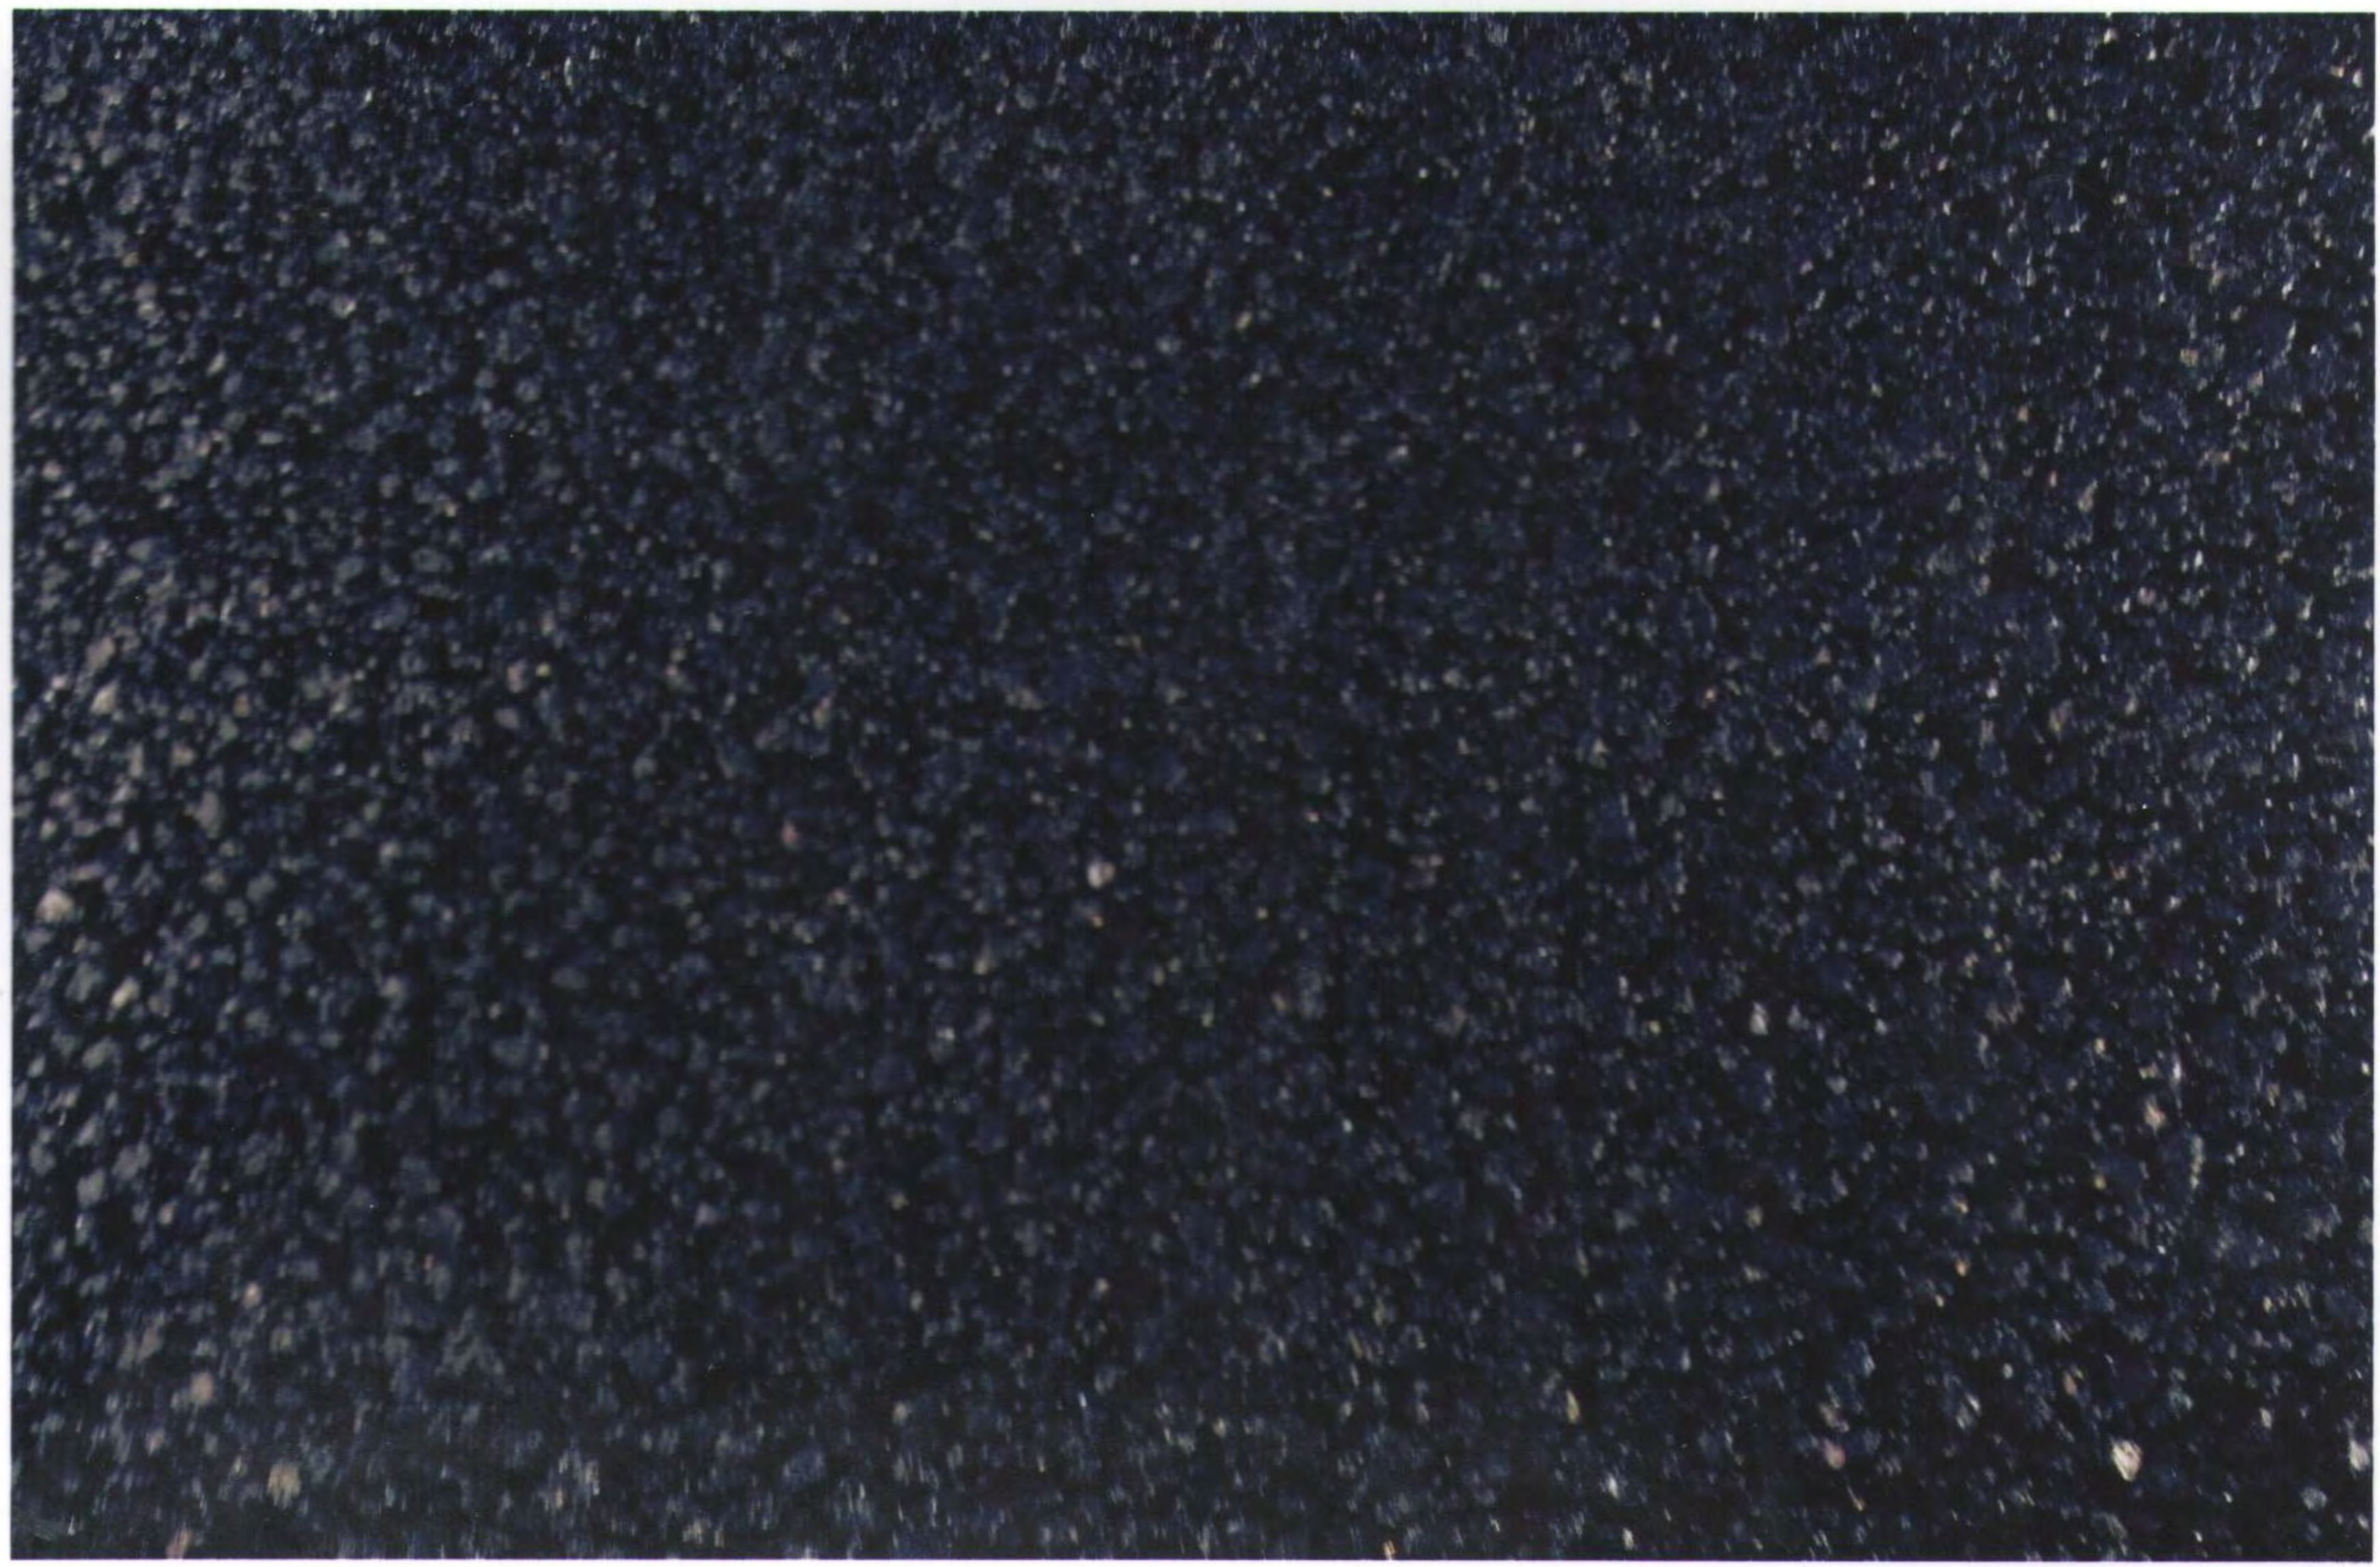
Крупный план поверхности слоя асфальтобетонной смеси на покрытии
